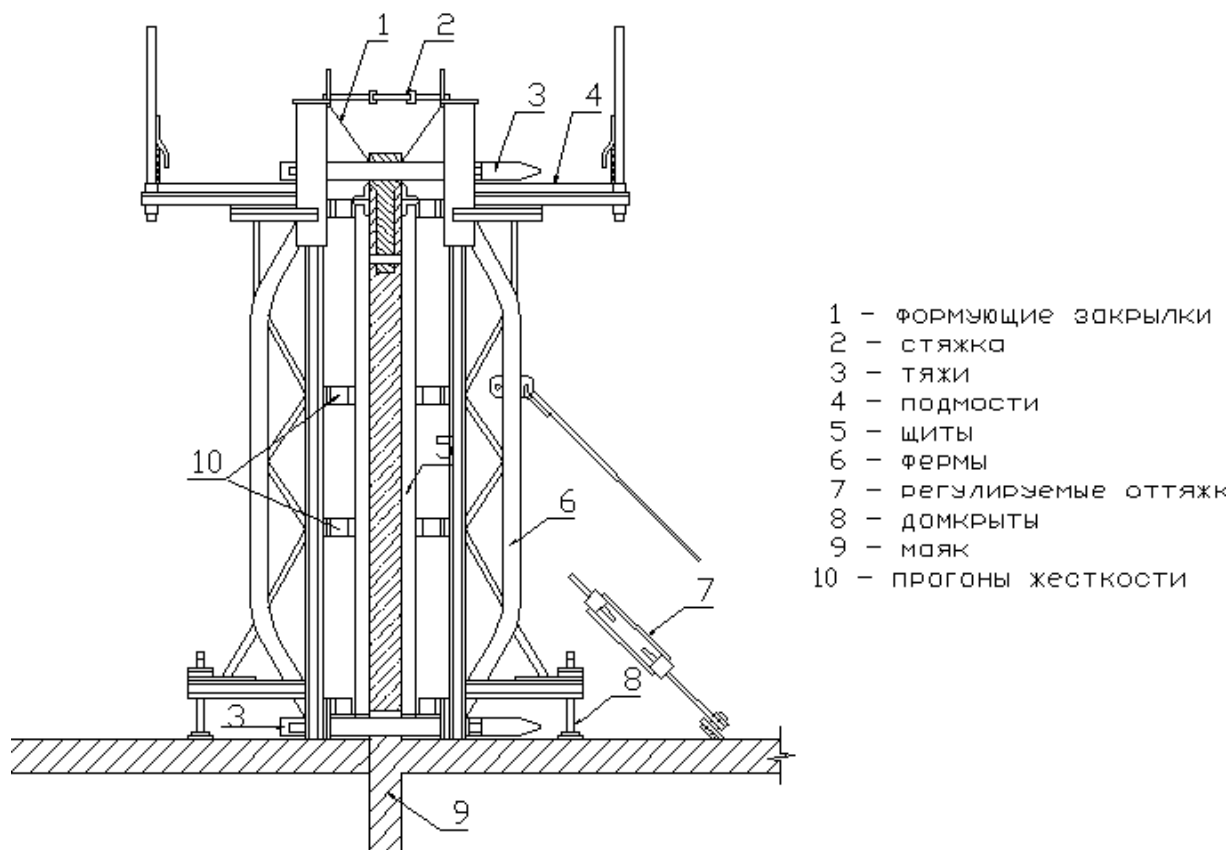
Принципиальная схема монтажа опалубки монолитных стен
